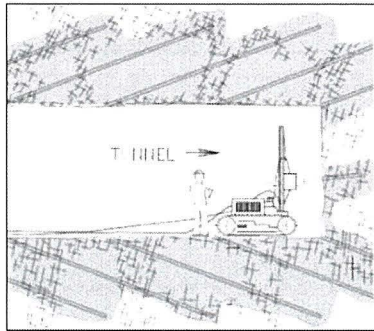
Pre-consolidation grouting ahead of tunneling excavation ^{2.28)}
